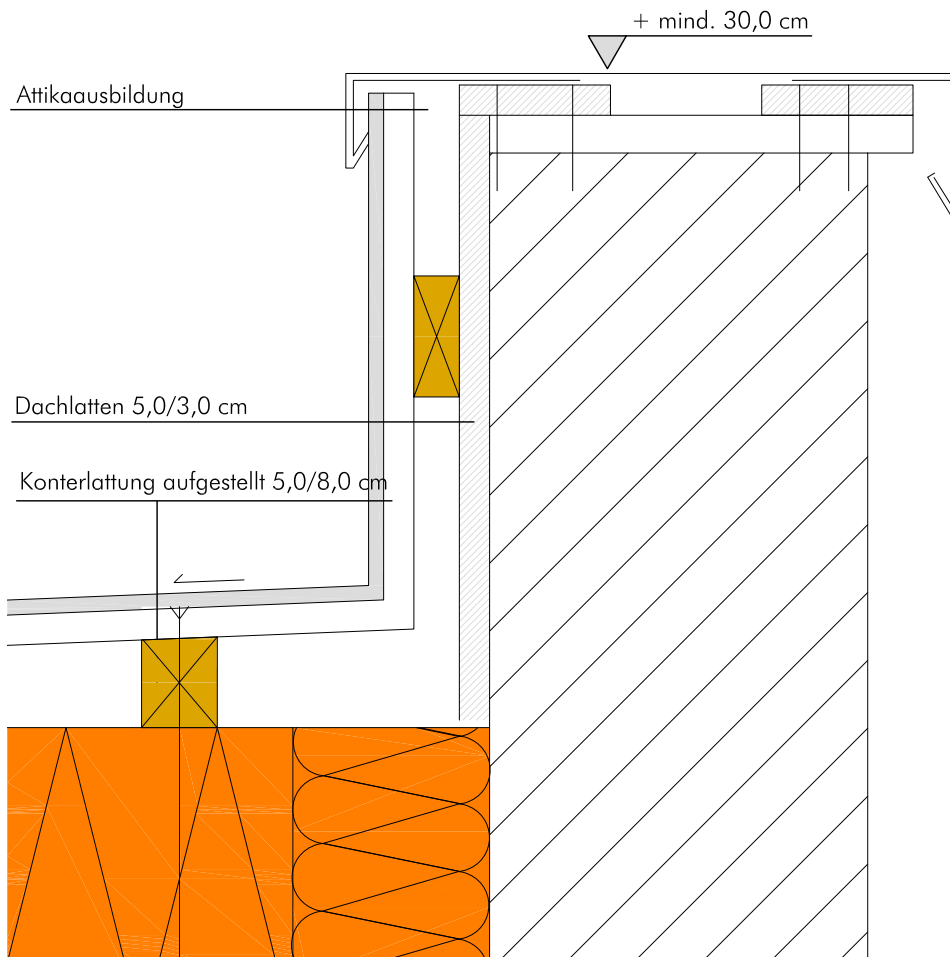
Detail A: Anschluss Dachdeckung mit Feuermauer M 1:5
